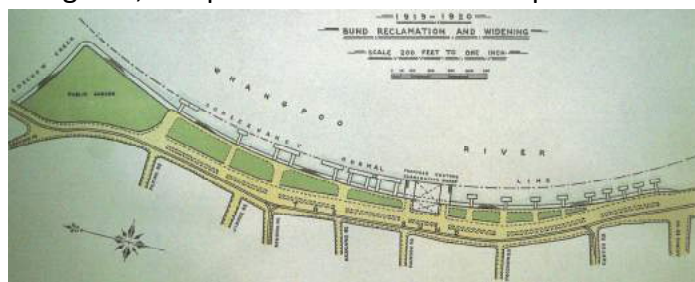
Sistemazione del lungofiume sul Bund, 1920. In Edward Denison, Guang Yu Ren, "Building Shanghai, the history of China's Gateway", Wiley Academy, London, 2006.
